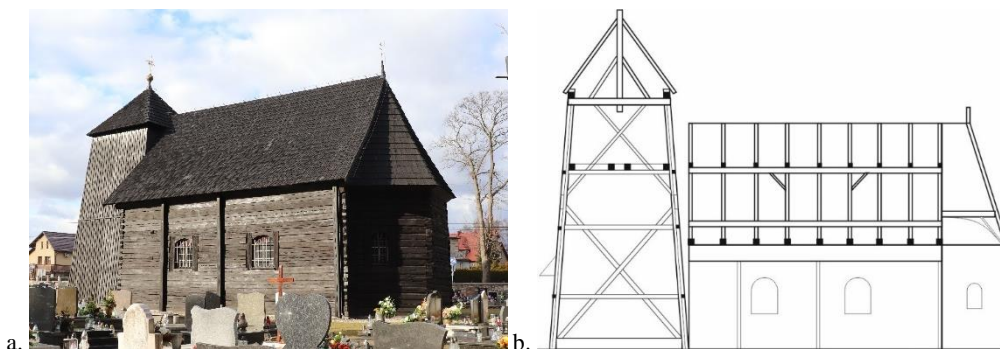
Przykładowe rozwiązanie dachu dwukalenicowego, kościół pw. Wszystkich Świętych w Sierotach: a. widok elewacji południowej, fotografia własna (2019), b. schemat przekroju podłużnego, opracowanie własne
